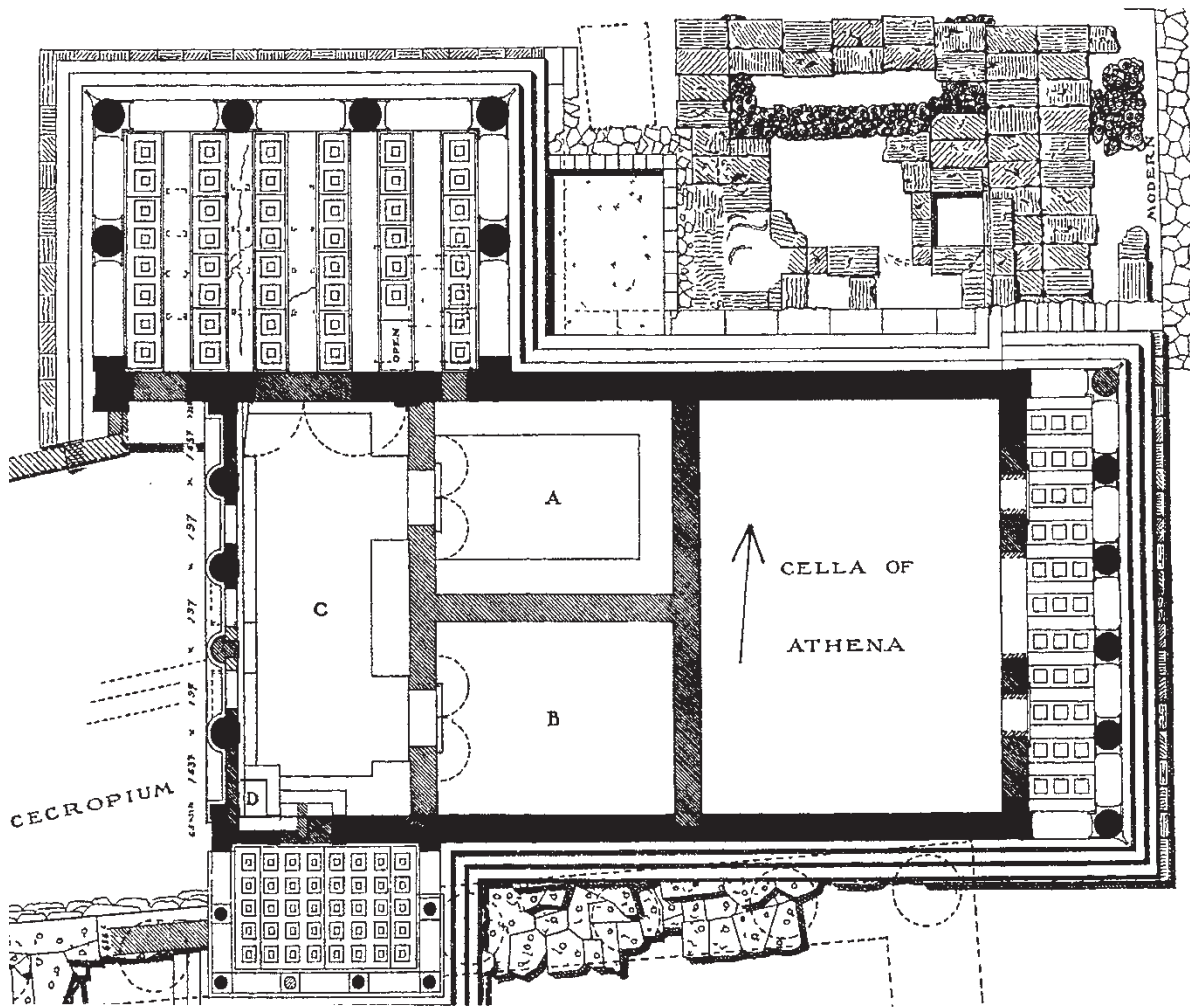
Erechtheion, Grundriss nach Paton & Stevens (1927)
